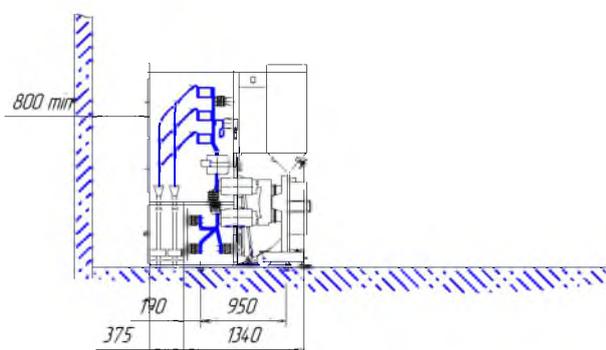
Установка шкафов кабельного ввода снизу вне шкафа на токи 630...1600 А на фундамент
